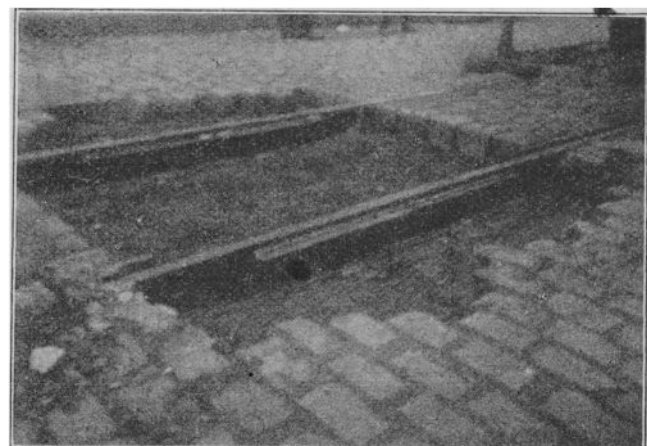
Durch Schweißung ausgebesserter Haarmann-Verblattstoß (Ersatz des Blattstoßes durch ein Schieneneinsatzstück).
